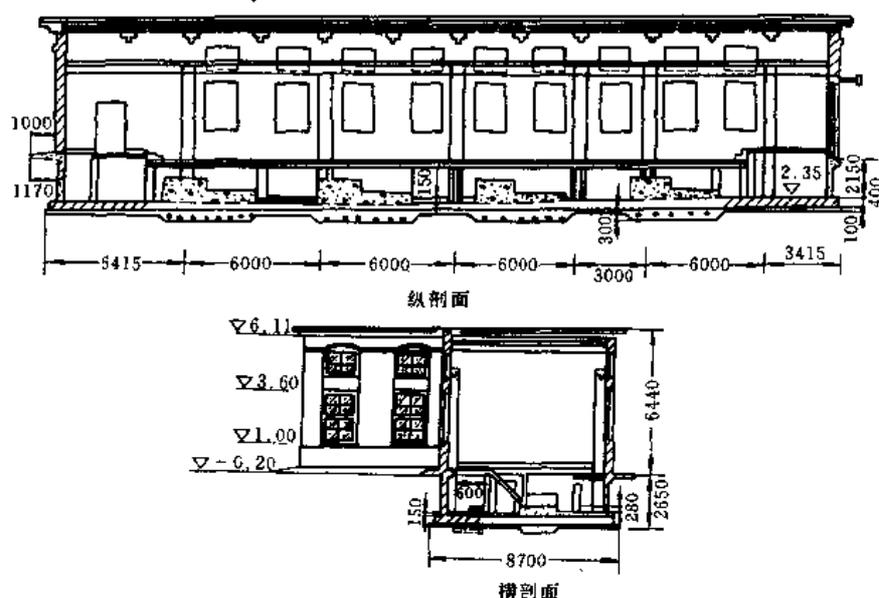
长方形干室型泵房剖面图 (单位: mm)
